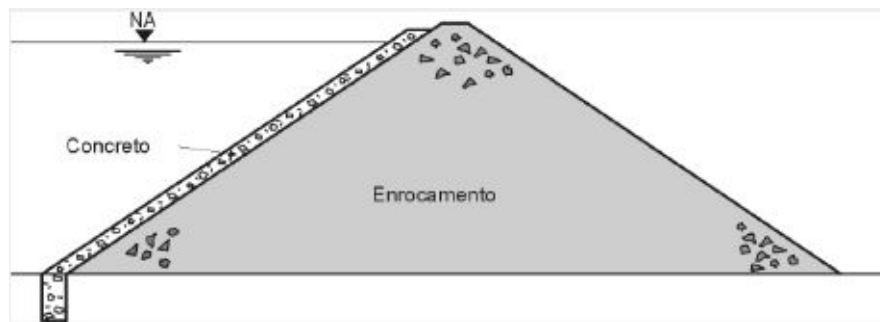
Barragem de enrocamento com face de concreto. Fonte: (MASSAD, 2010)
